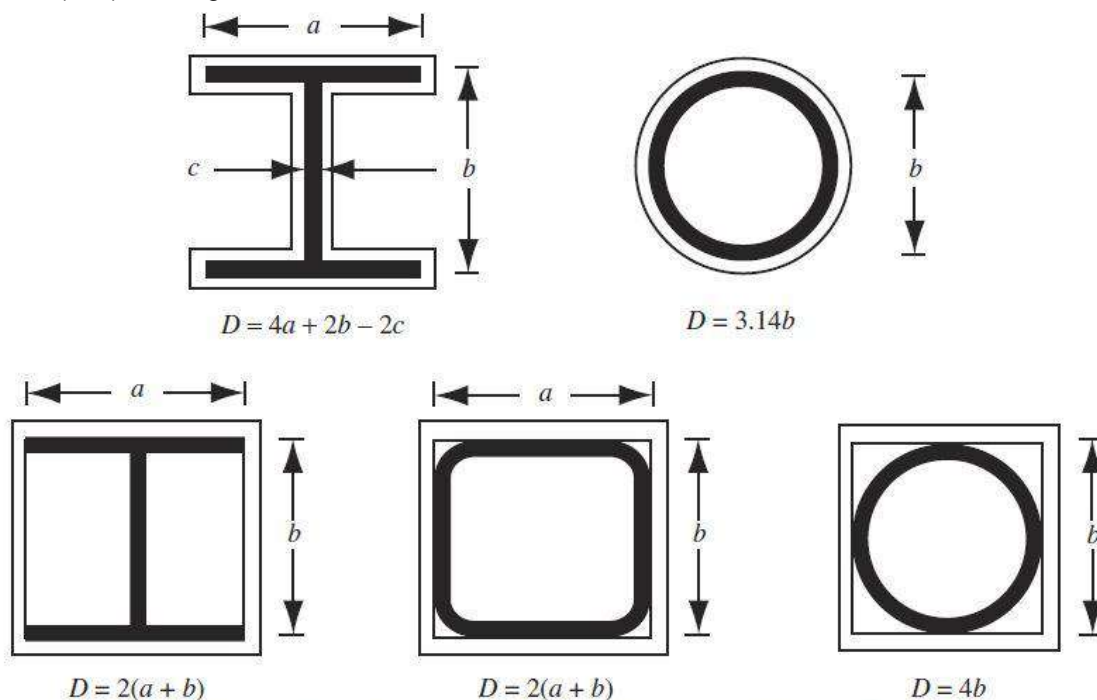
Determinación del perímetro de columnas de acero expuesto al fuego (D)
